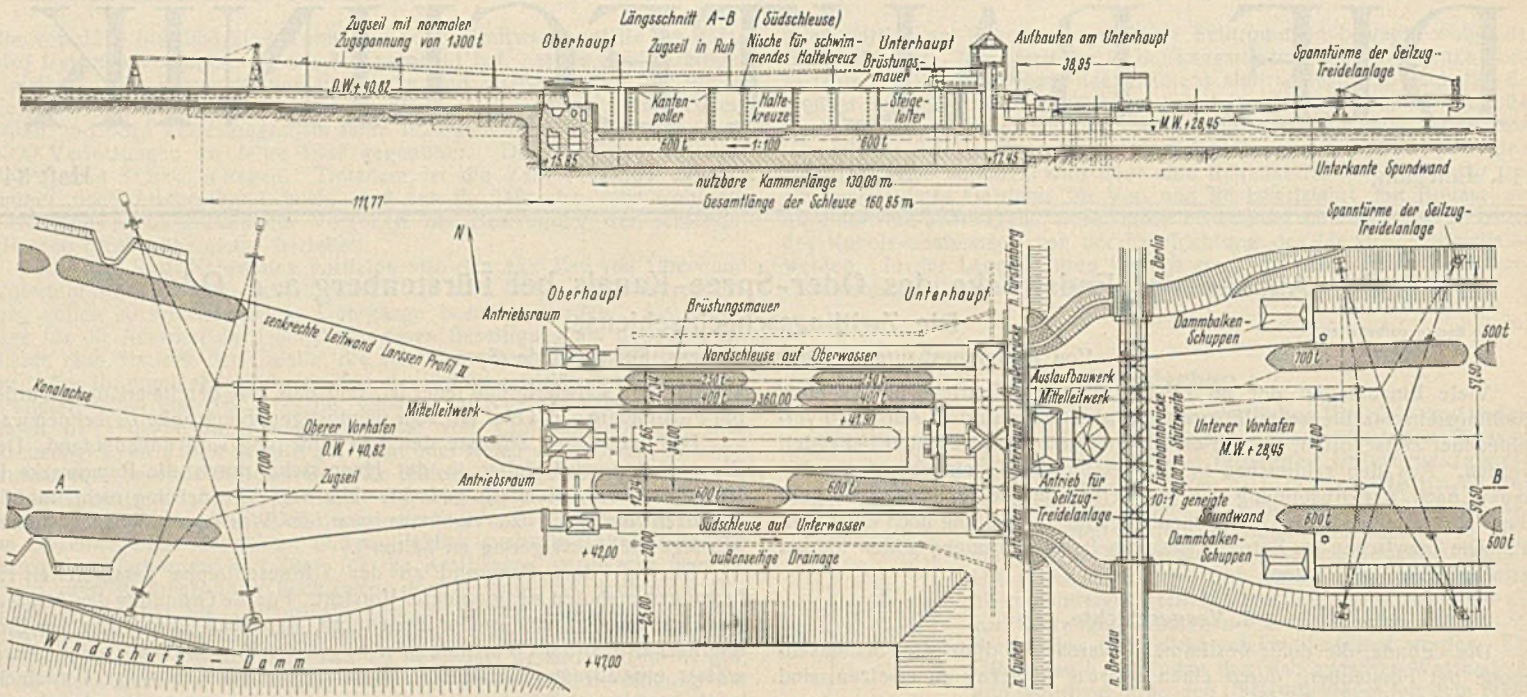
Zwillingschachtschleuse. Längsschnitt und Grundriß.
